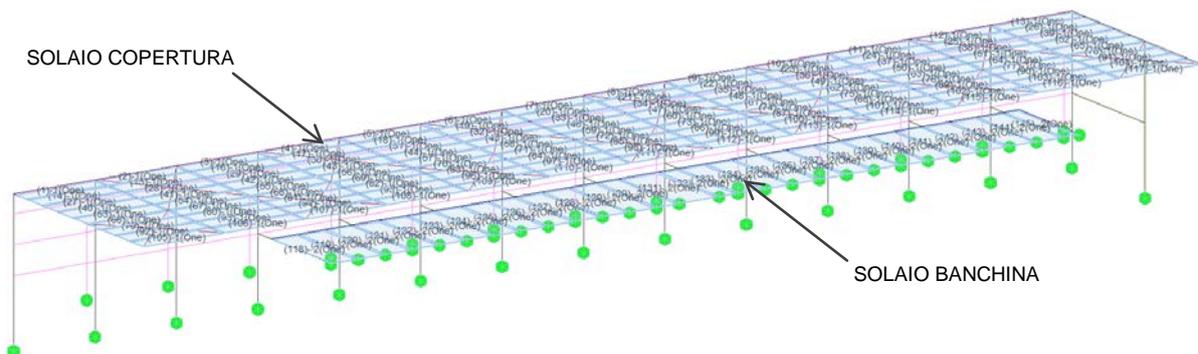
Modello FEM 3D – Individuazione tipologie di solai di piano applicati
